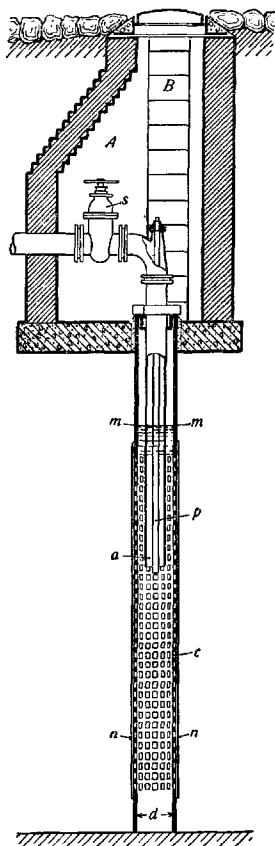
Бруклинский колодец: А — шахта; з — задвижка; Б — лестница; а — всасывающая труба; м — стенки колодца; т — горизонт воды при откачке; п — медная сетка; d — диаметр колодца; р — наблюдательная трубка.
